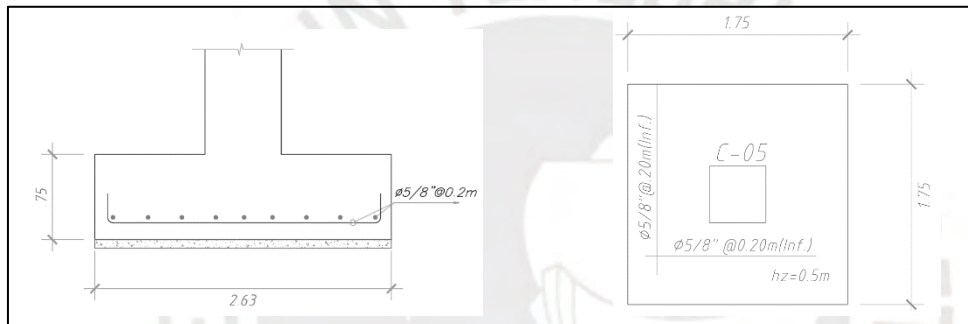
DISEÑO FINAL DE LA ZAPATA AISLADA.
